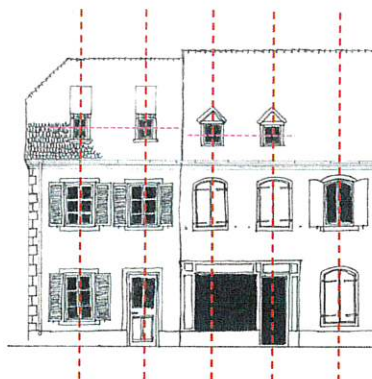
Schéma du concept d'ordonnement de façade et de toiture
